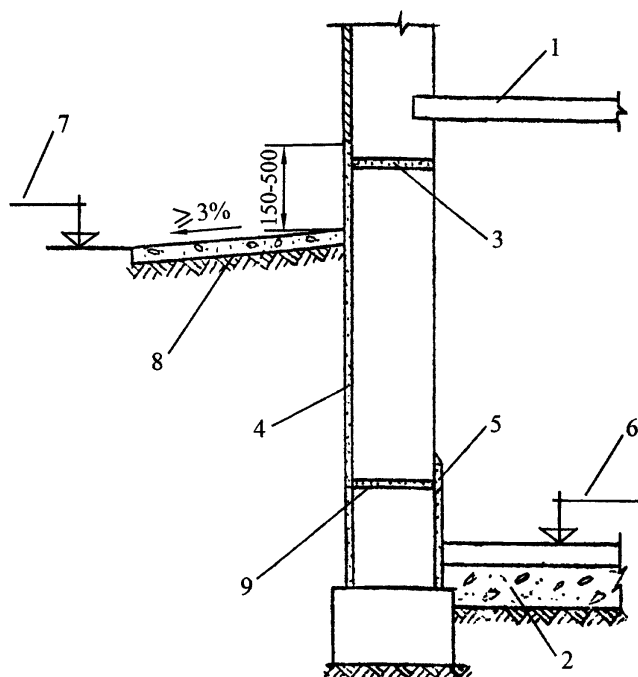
Устройство прокладок в стенах с подвалами при высоко расположенном перекрытии подвала
